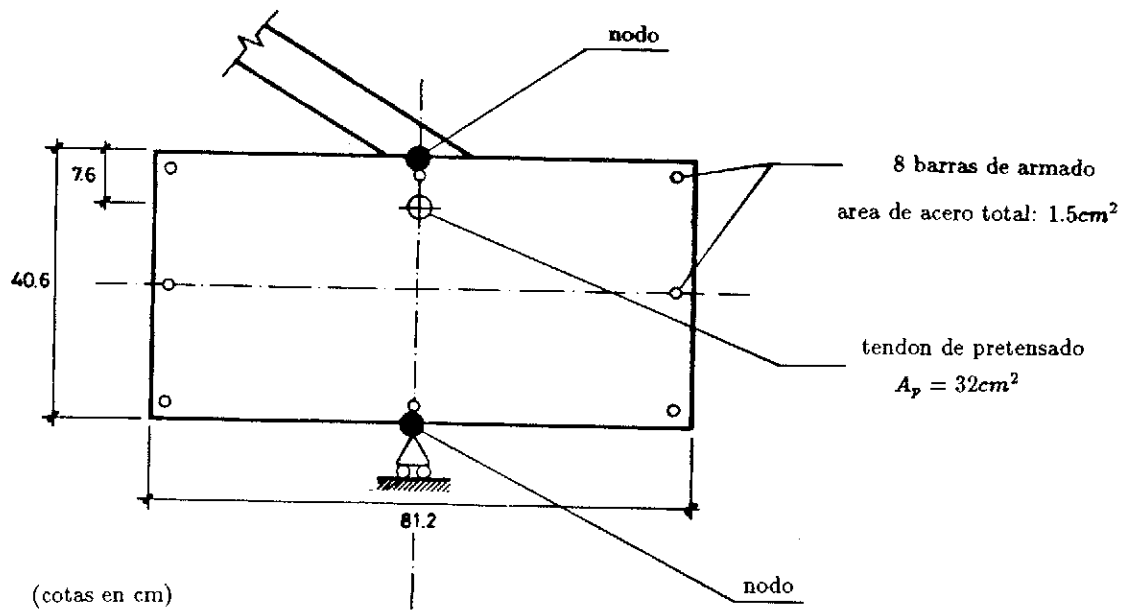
Ejemplo 1*— Geometría y distribución de la armadura, en la viga de borde.
